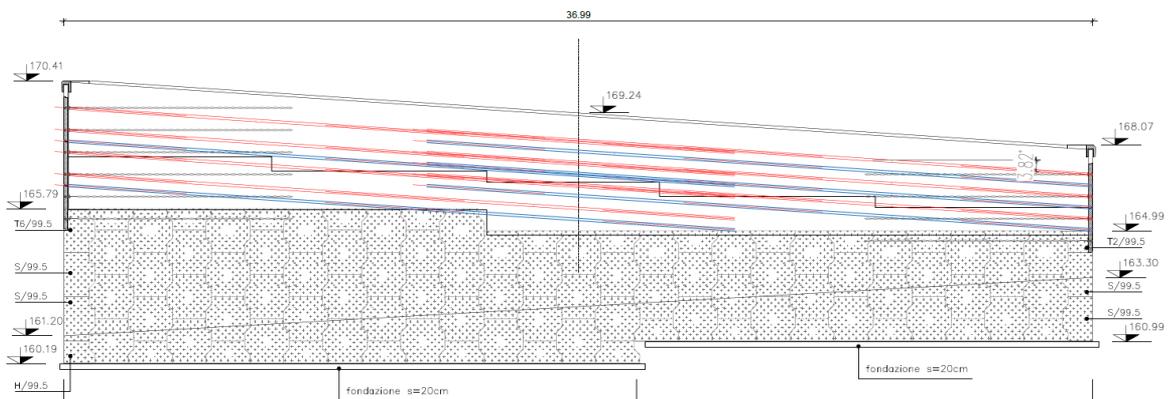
Disposizione delle iniezioni a tergo della Spalla 1 del Viadotto 2
